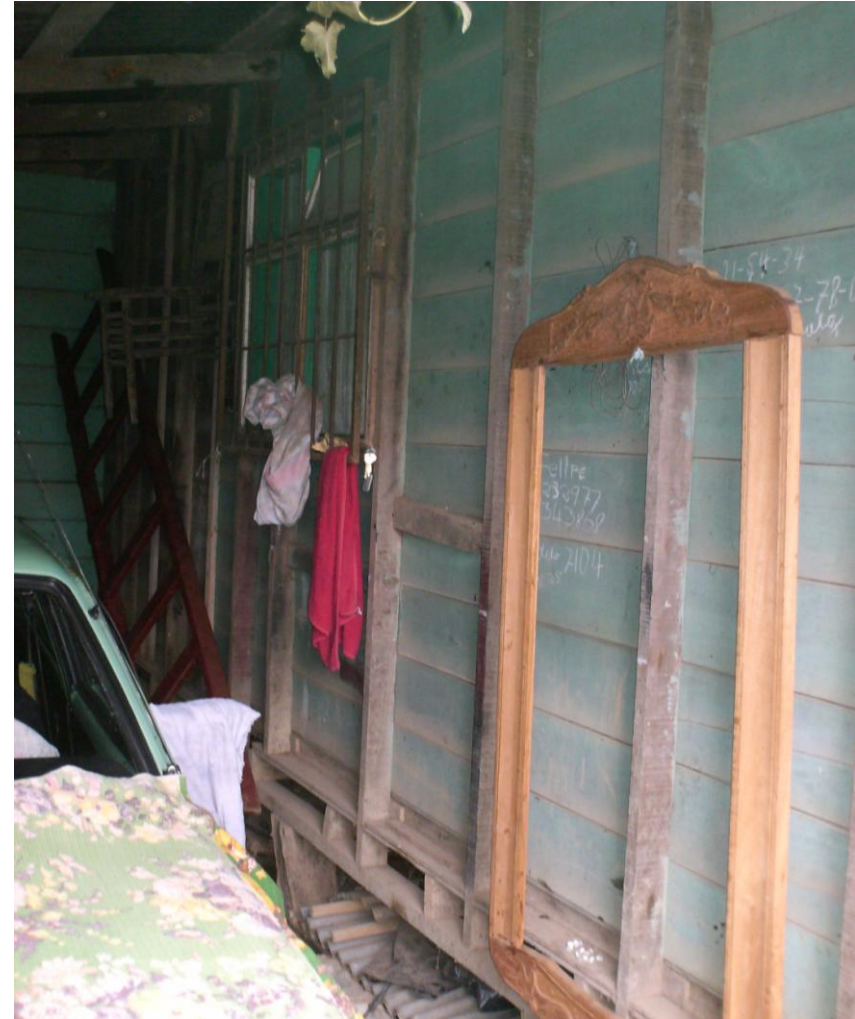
Vivienda Álvaro Picado. Detalle Pared y Entrepisos. Vásquez de
